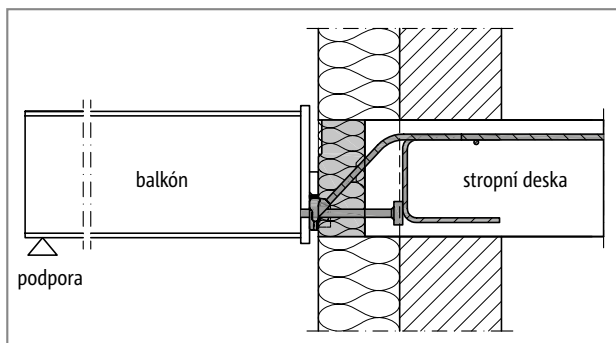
Schöck Isokorb® T typ SQP: Napojení na železobetonovou stropní desku; stěna z monolitického betonu
